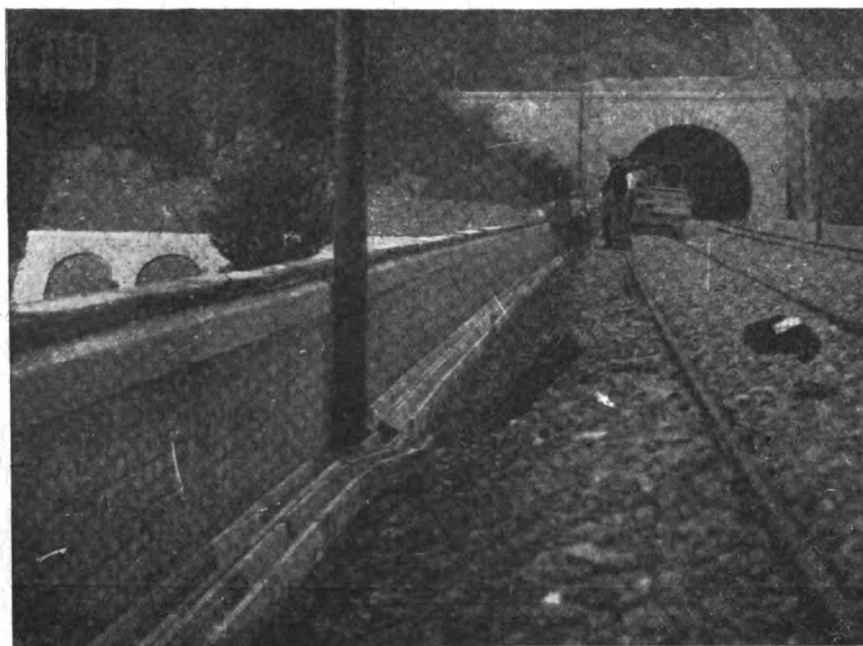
Sistemazione del cavo con cassetta di cemento su ponte in muratura.
